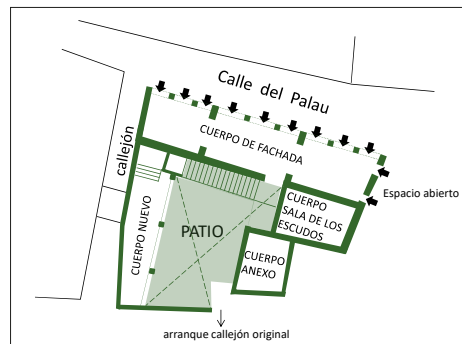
Plano de planta baja de la Casa de Vila-rasa entre la segunda mitad del siglo xiv y principios del siglo xv.
